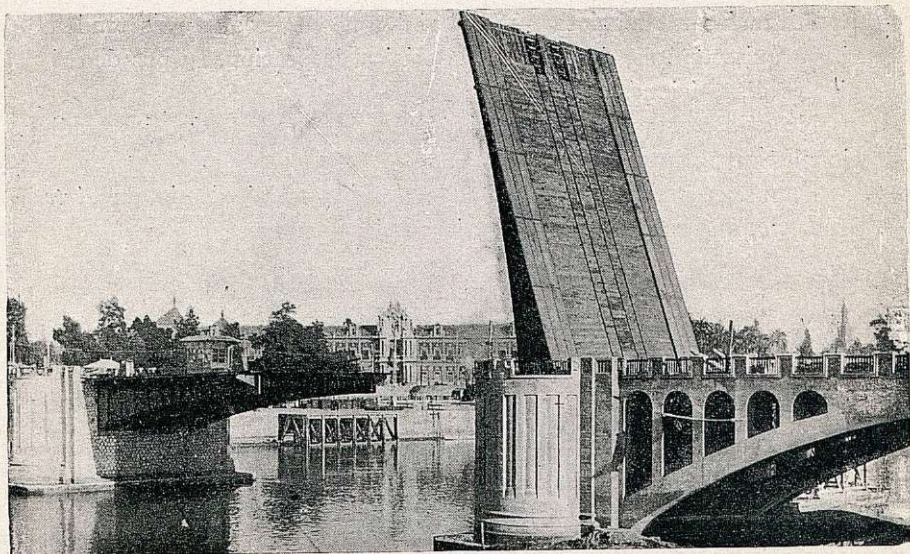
Puente de San Telmo (más detalles en el capítulo IV).
